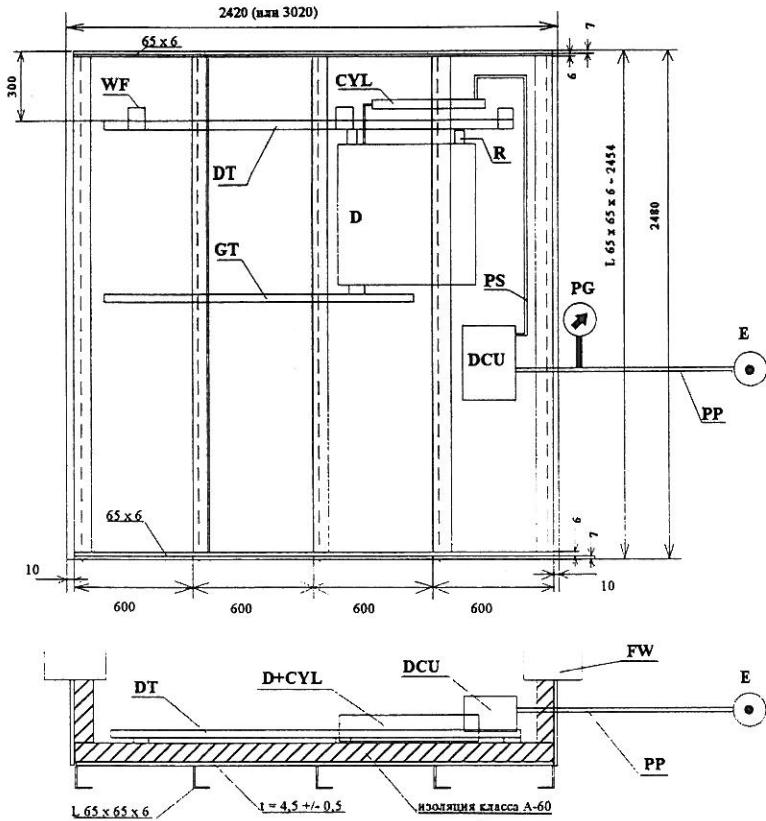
Основа конструкции для установки прототипа системы управления противопожарными дверьми.
